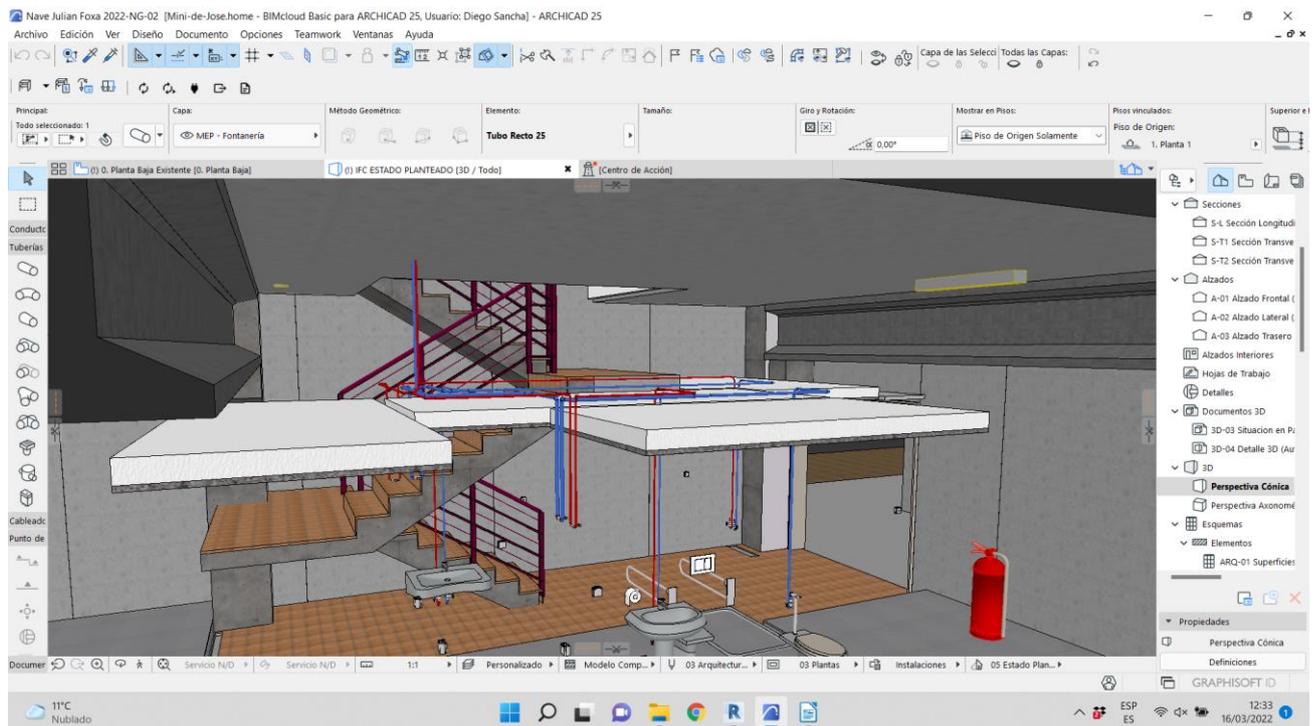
Instalación de fontanería en ArchiCAD (2).
